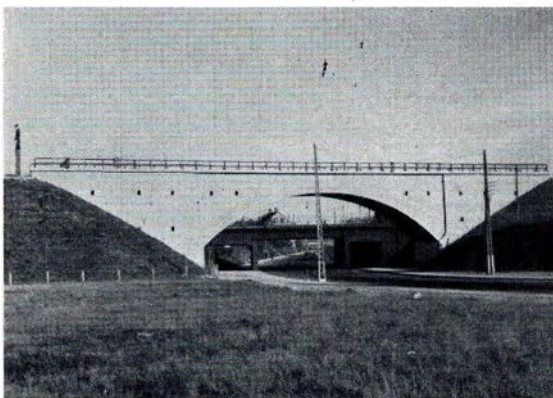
Underføring for Vigerslevvej Vest for Valby. Betonhvælving med Spændvidde 30,0 m. Fuldført 1944.
